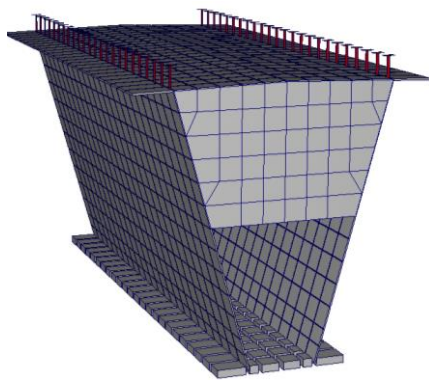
Расчетная схема сталежелезобетонной балки
